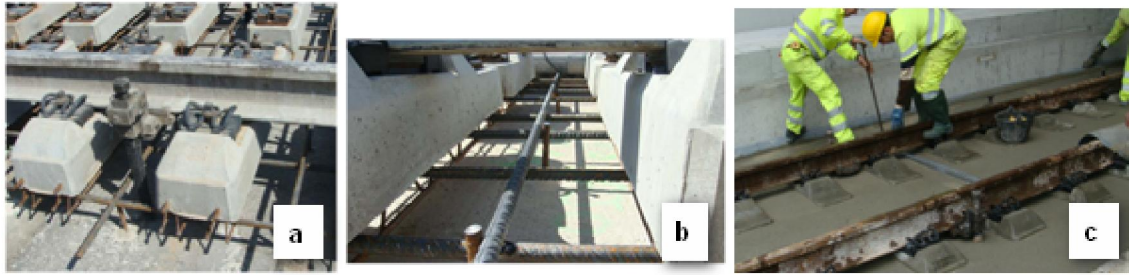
a) Armat de la placa b) Armadura transversal de la llosa superior. c) Junta transversal de fisuració. Extret de [9].
